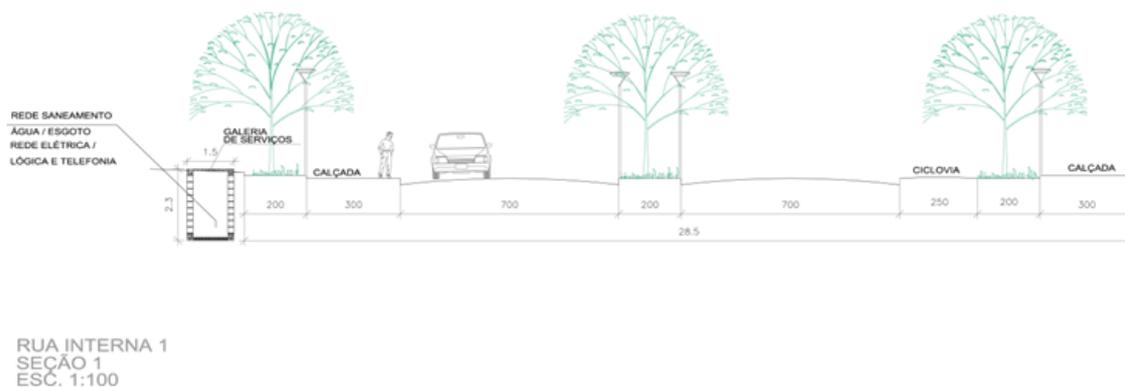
Perfil Rua Interna 1 – Faixa de Serviço.
